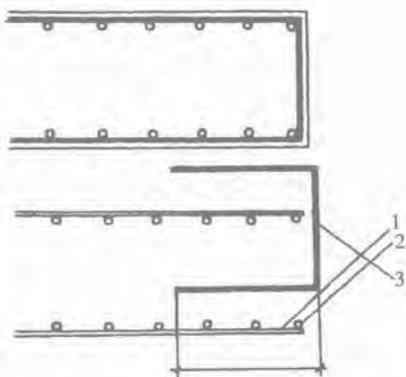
钢筋焊接网在墙体端部(无暗柱)的构造图
